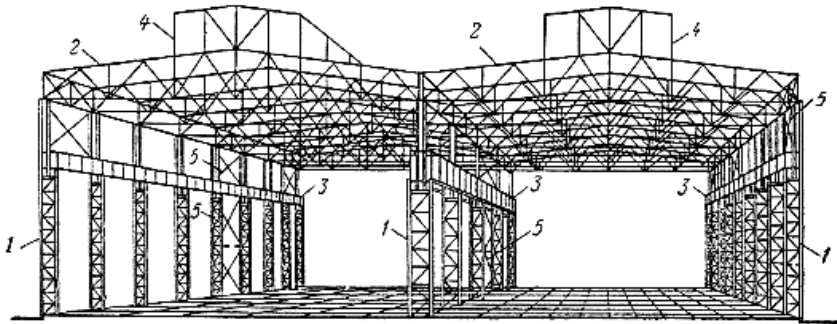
Конструктивна схема каркаса двопролітної промислової будівлі:
